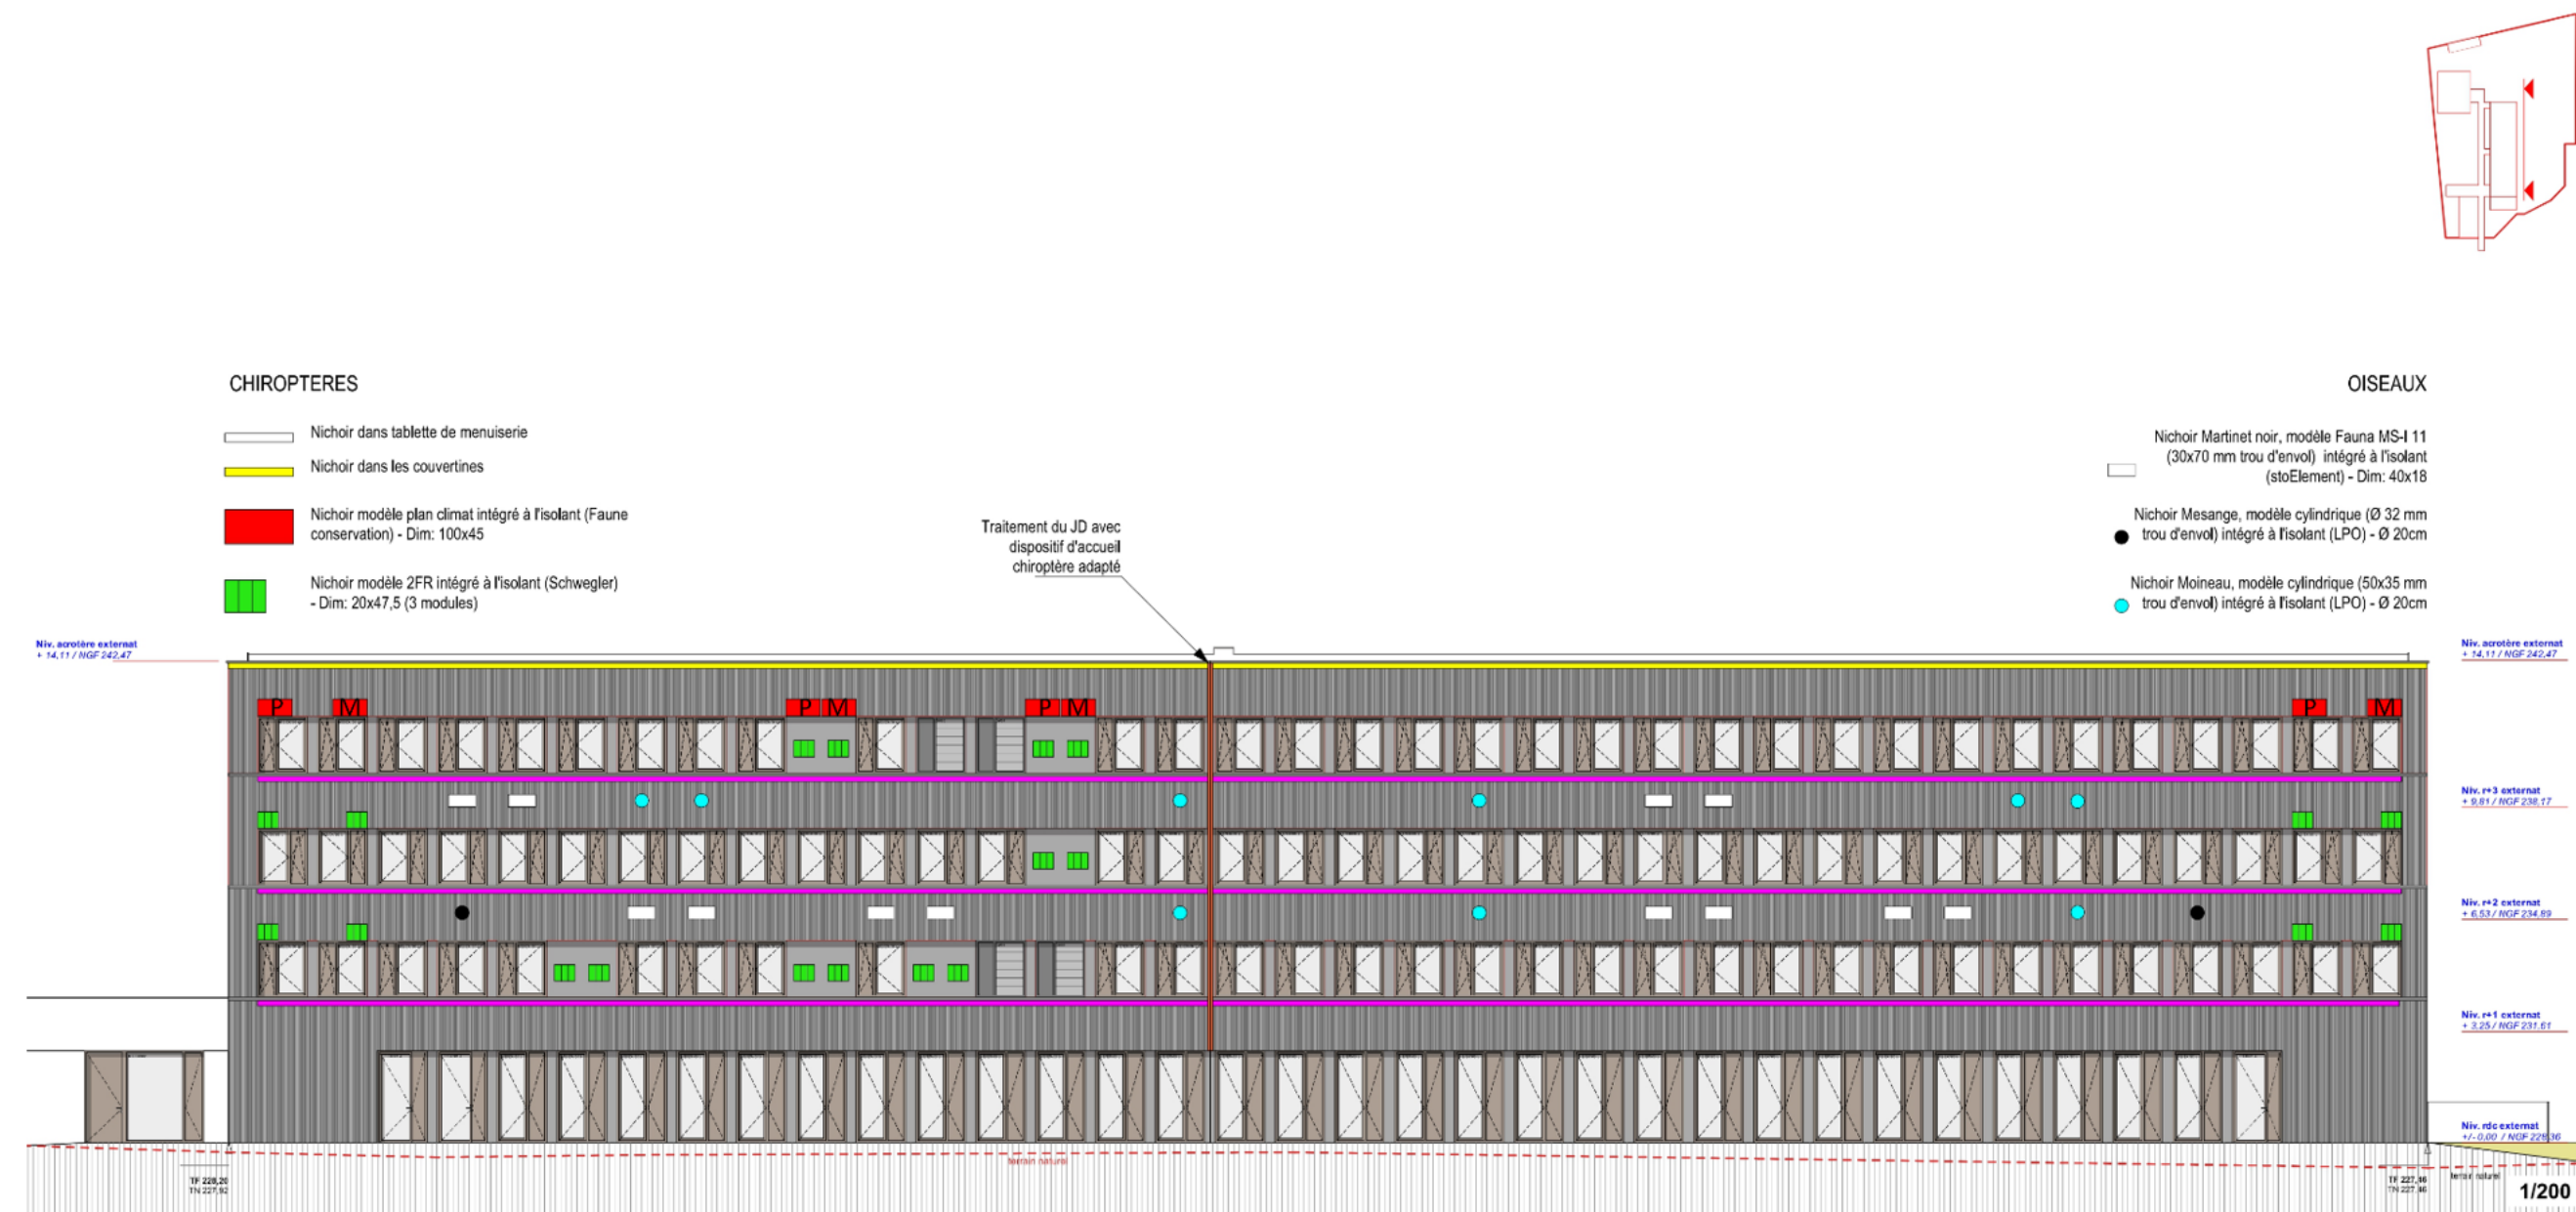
Localisation des gîtes compensatoires sur le bâtiment externat - façade est
